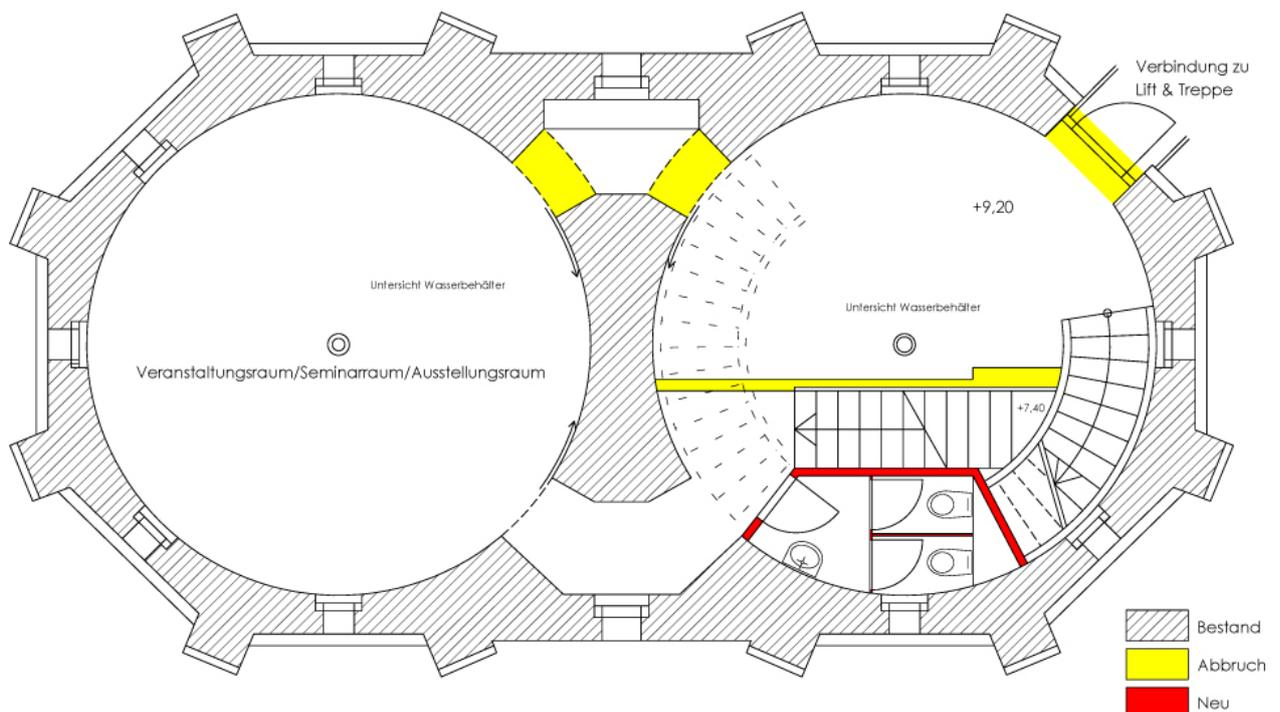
Grundriss Ebene 2 Wasserturm - Veränderungen
